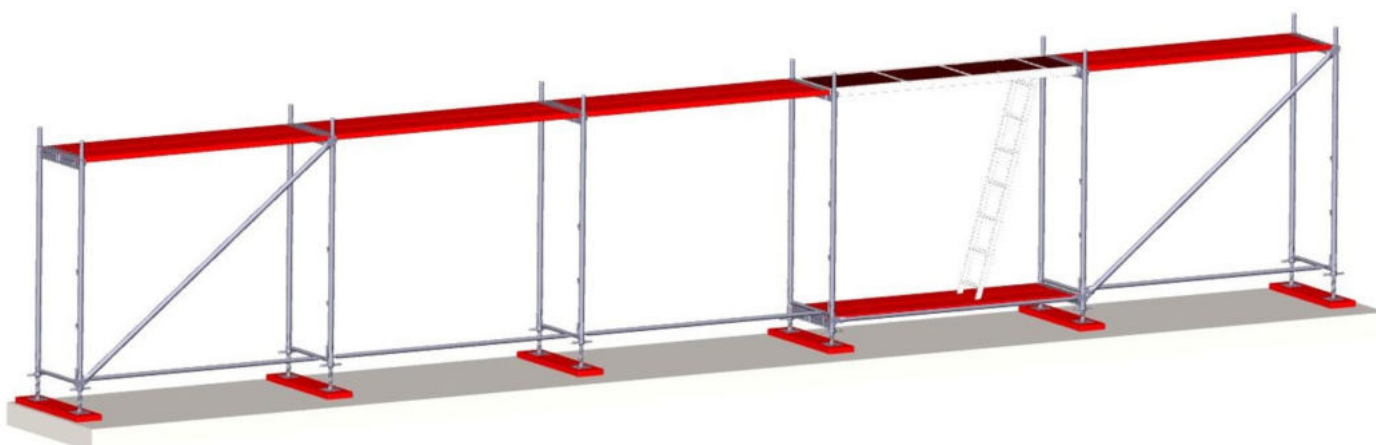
Montaż pierwszego pola rusztowania – pole bazowe.
